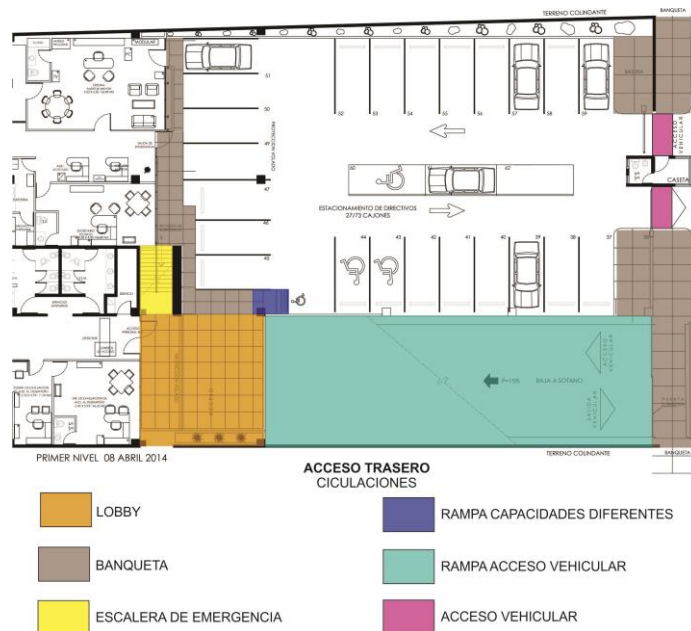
Circulación en fachada posterior. Autor: Eva Zavala
